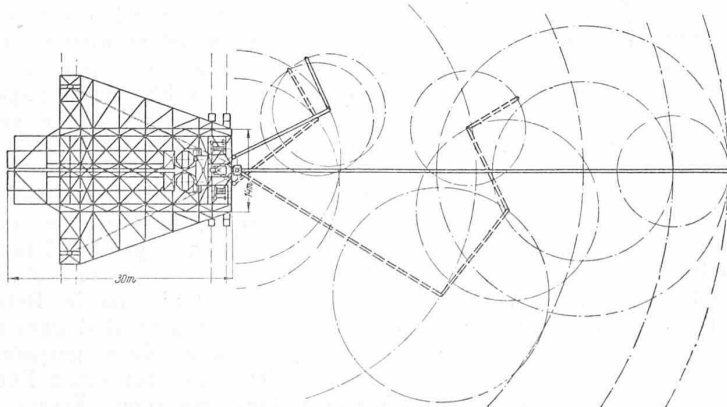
Schema der Gussbeton-Anlage auf der Schleusen-Baustelle. (Nach „VDI-Zeitschrift“.)
